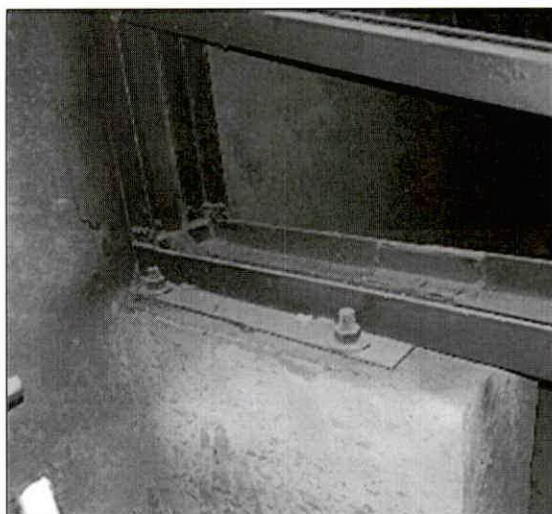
Vista de tijerales metálicos sobre pedestales y vigas tipo celosía – Sector B. los elementos metálicos de la cobertura en general presentan buen estado.
